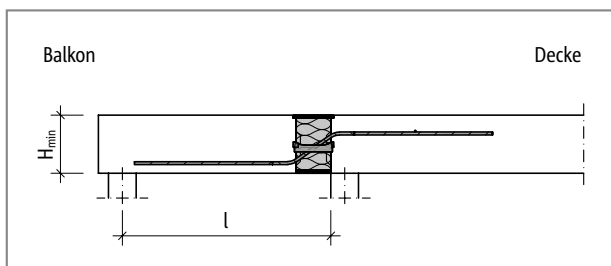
Schöck Isokorb® XT Typ QL: Statisches System (XT Typ QL-V5 bis V8)
